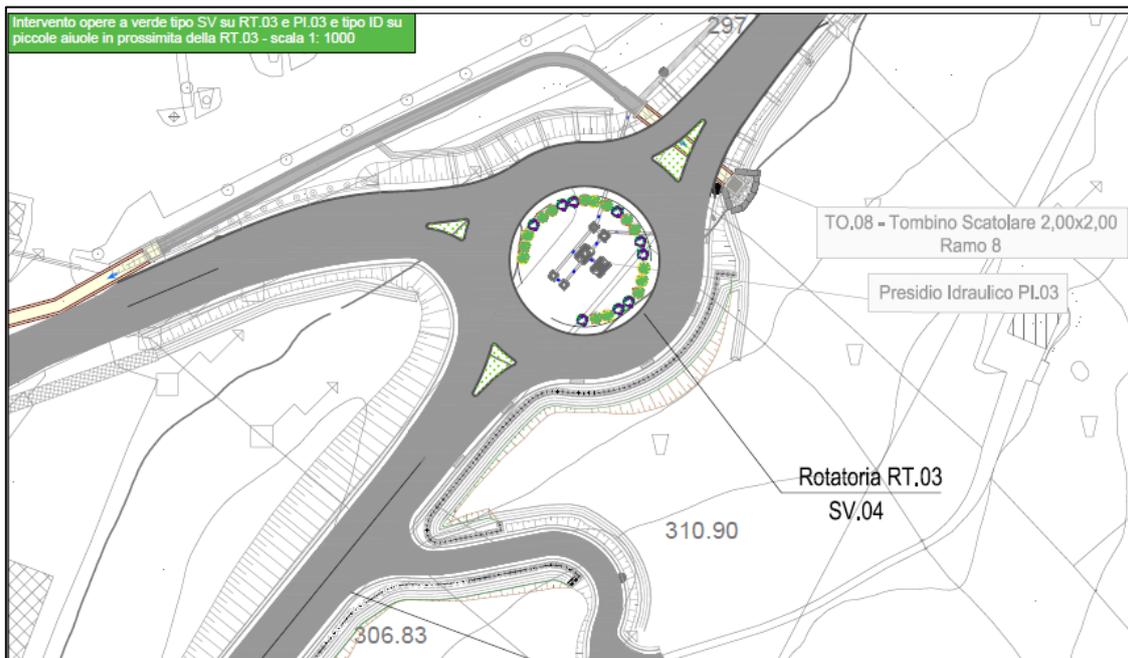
Intervento SV su RT.03 e PI.03 - planimetria
